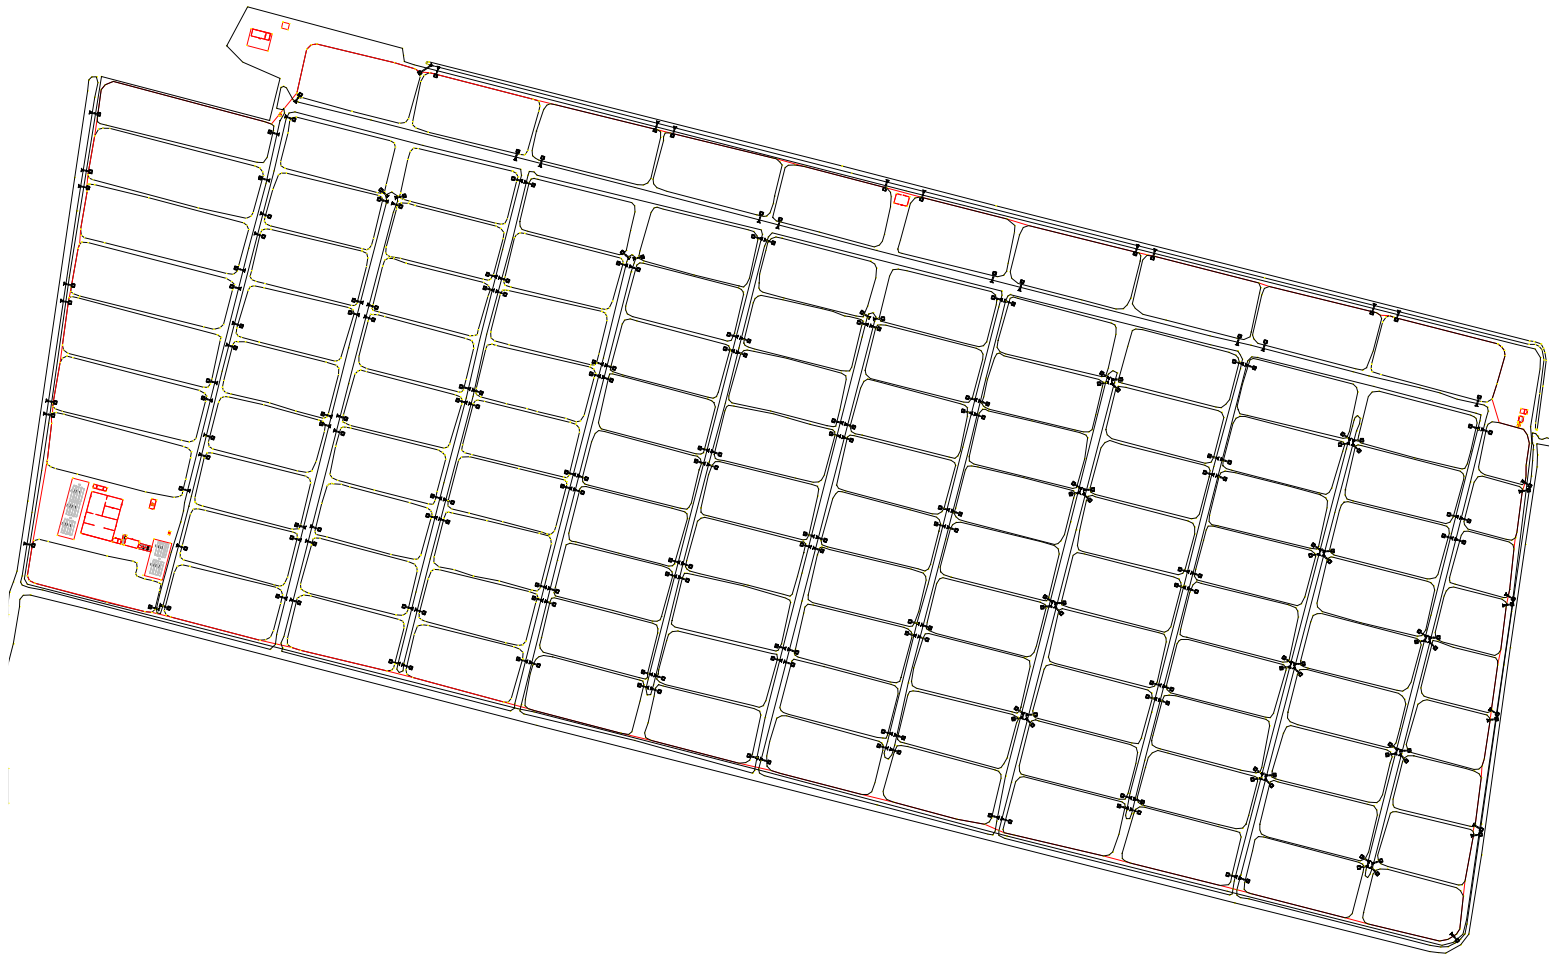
Plano de construcción general, Acuícola Playa de Oro, S.P.R. DE R.L. de C.V.
